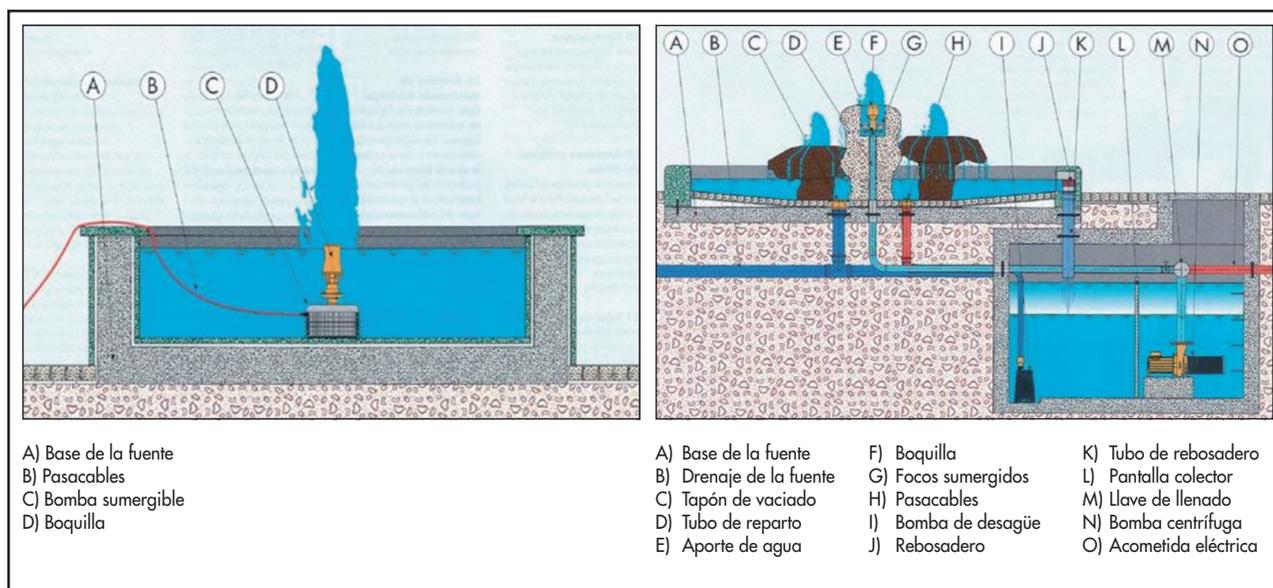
Izquierda, fuente con bomba sumergida; derecha, fuente con circuito de recirculación. Fuente: Guía Técnica del Ministerio Sanidad.
